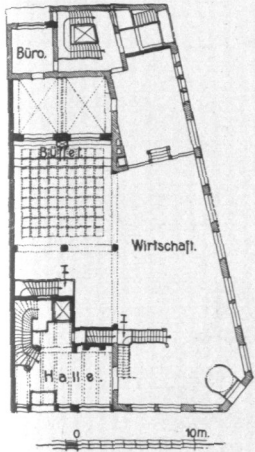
Lloyd-Hotel, Erdgeschoß, Grundriß.
